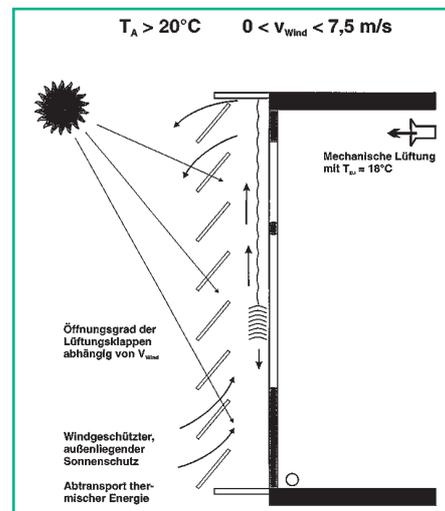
Funktionsschema Glas-Doppelfassade Sommer
